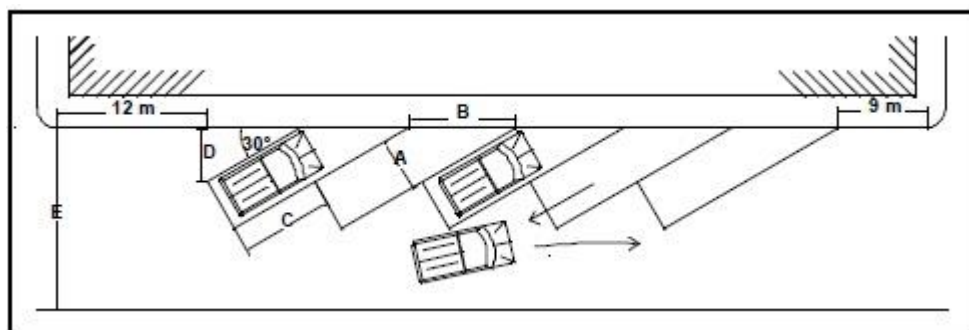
3 Parkir Paralel Pada Jalan Turunan
